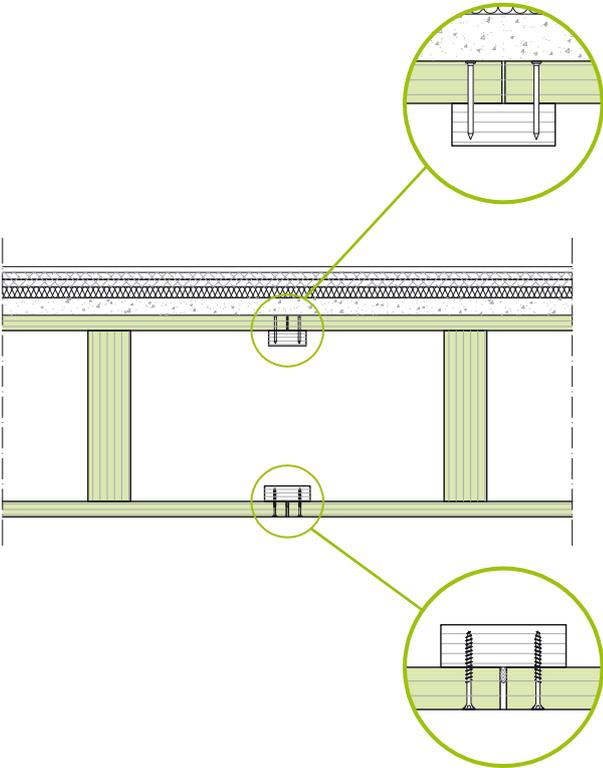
DETAIL: ELEMENTSTOSS KERTO-RIPPENELEMENT
